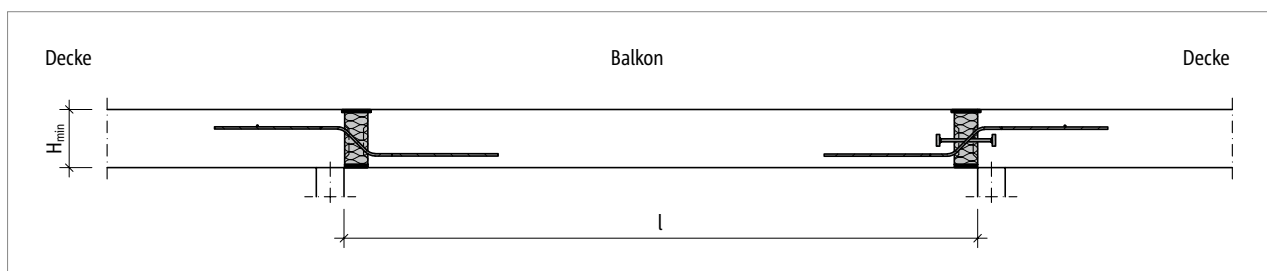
Schöck Isokorb® T Typ QP-Z, QP: Statisches System
